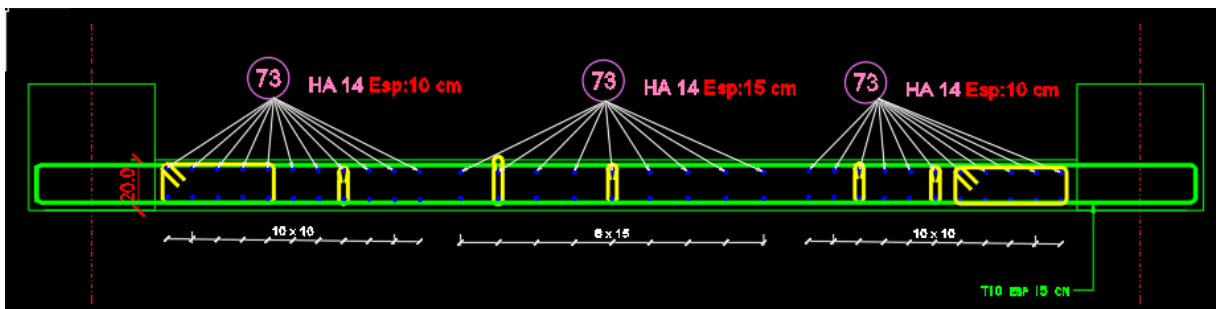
Exemple ferrailage voiles V1-V1'-V1'' de (1^{er}-5^{eme} étage)
